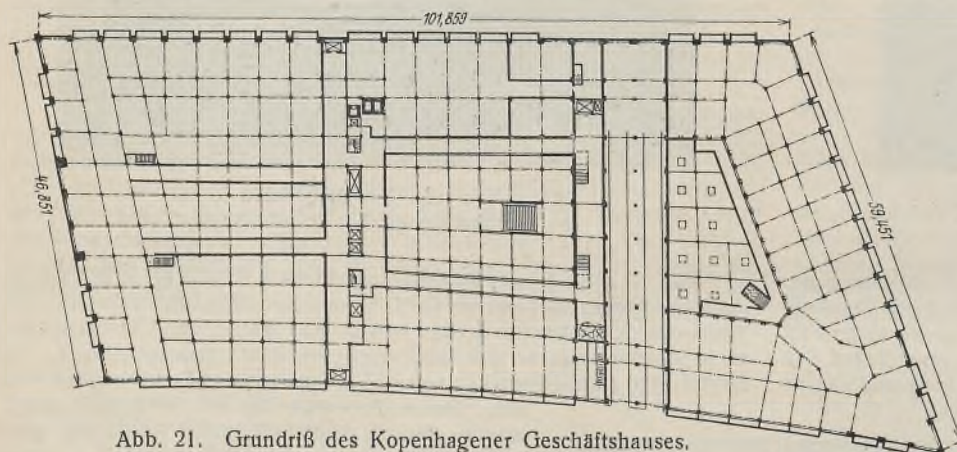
Grundriß des Kopenhagener Geschäftshauses.
